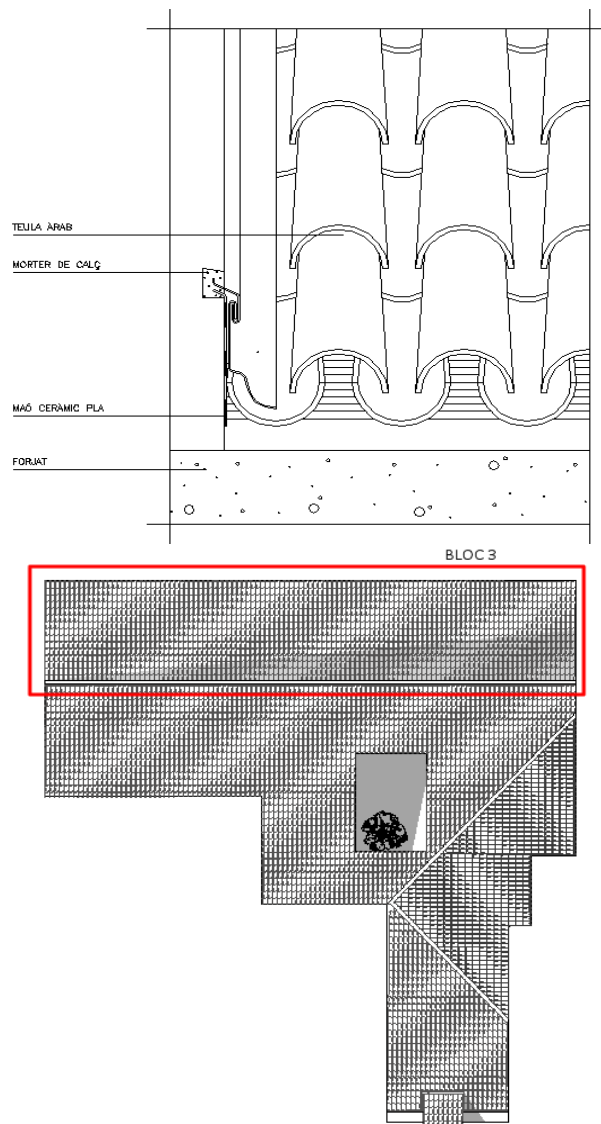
i 5.5.2. Detall coberta i Planta coberta. Bloc 3 → Dóna a corraló Bolcador.
